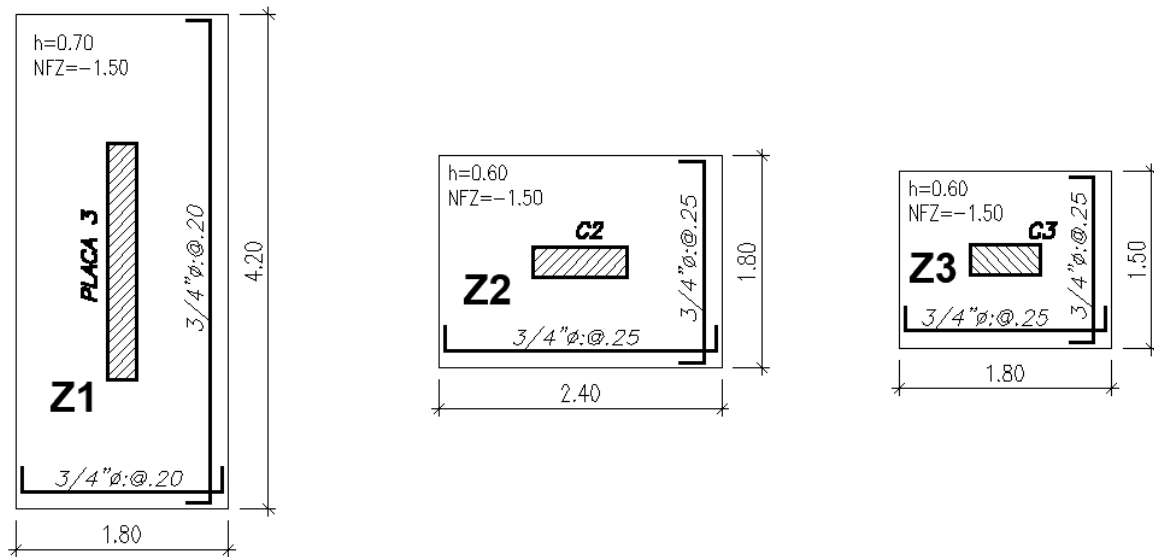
Dimensionamiento en planta y armado final de zapatas elegidas.
